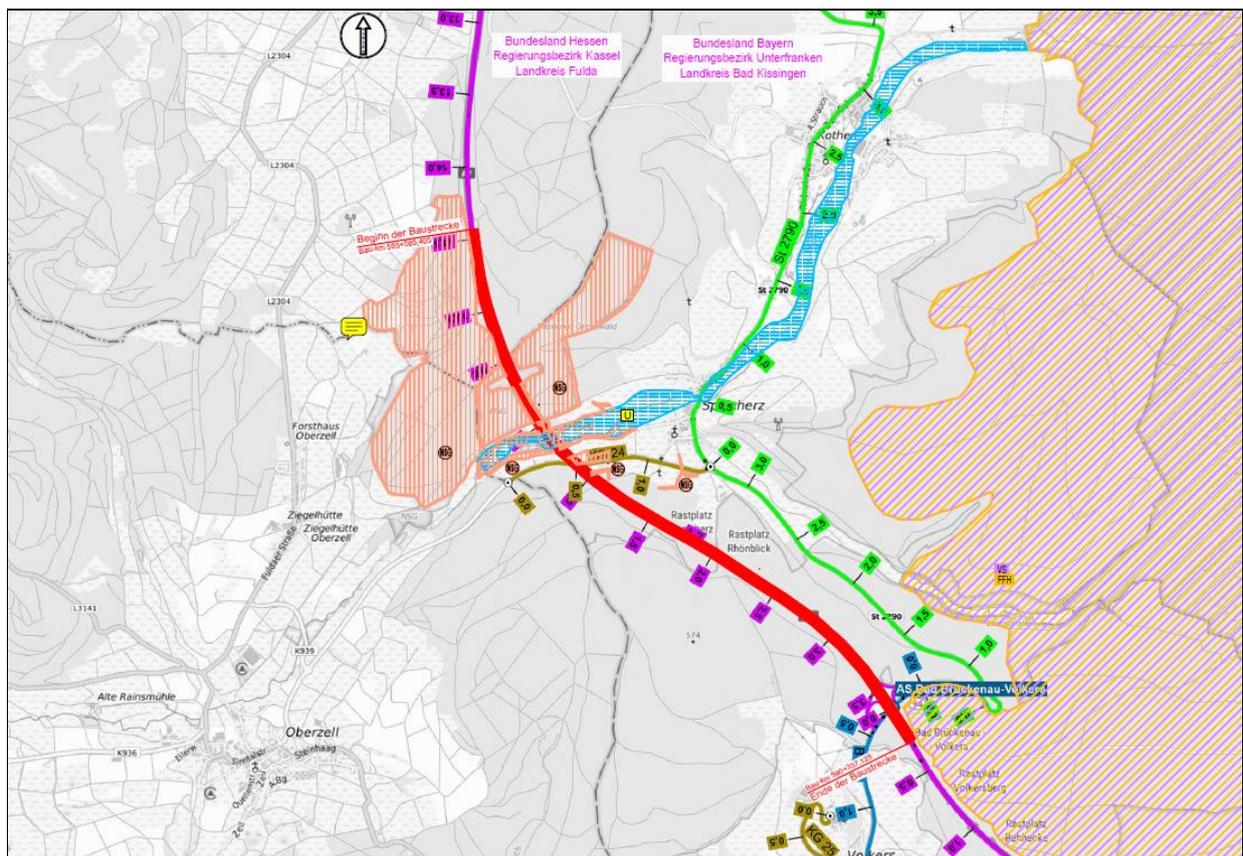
Übersichtslageplan zur Lage der Trasse
